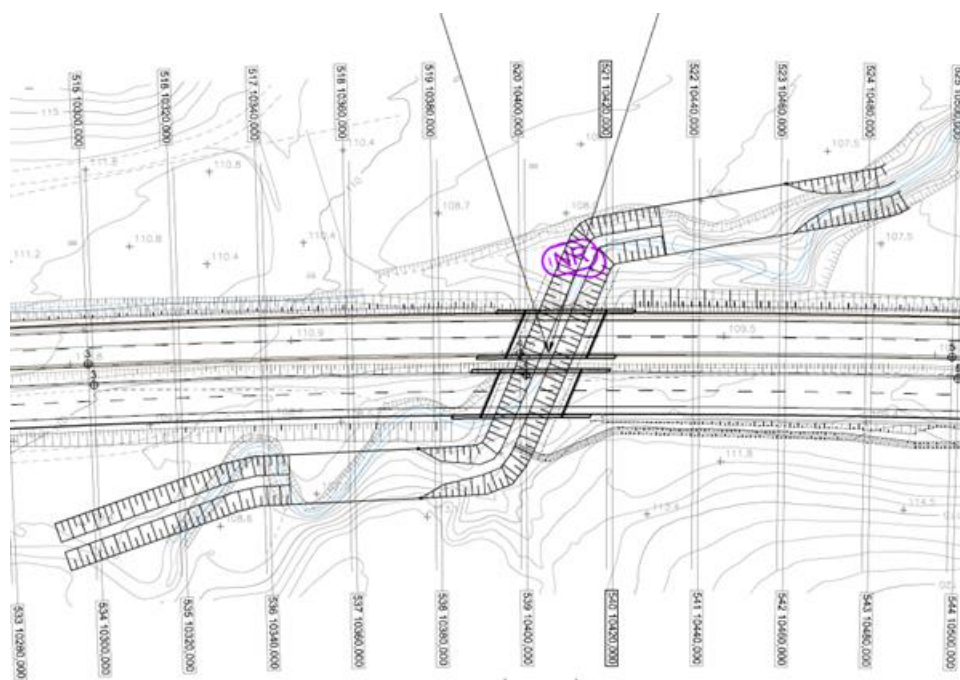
Inquadramento planimetrico della nuova opera VI19: sezioni modellate del fosso senza nome (planimetria modello idraulico)
